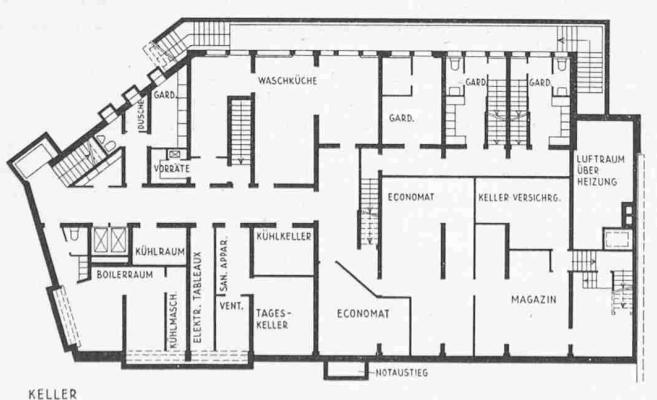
(links). Grundrisse, Maßstab 1:400
